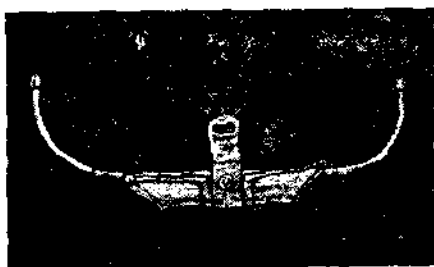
То же на трехпроводной деревянной опоре 115 кв.
